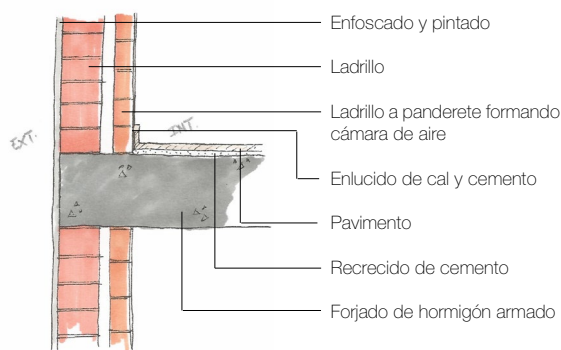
Sección encuentro fachada con forjado (autoría propia).
